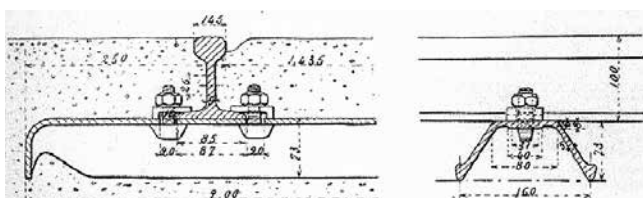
Coupes longitudinale et transversale d'une voie en rails Vignole (Aix-la-Chapelle).
